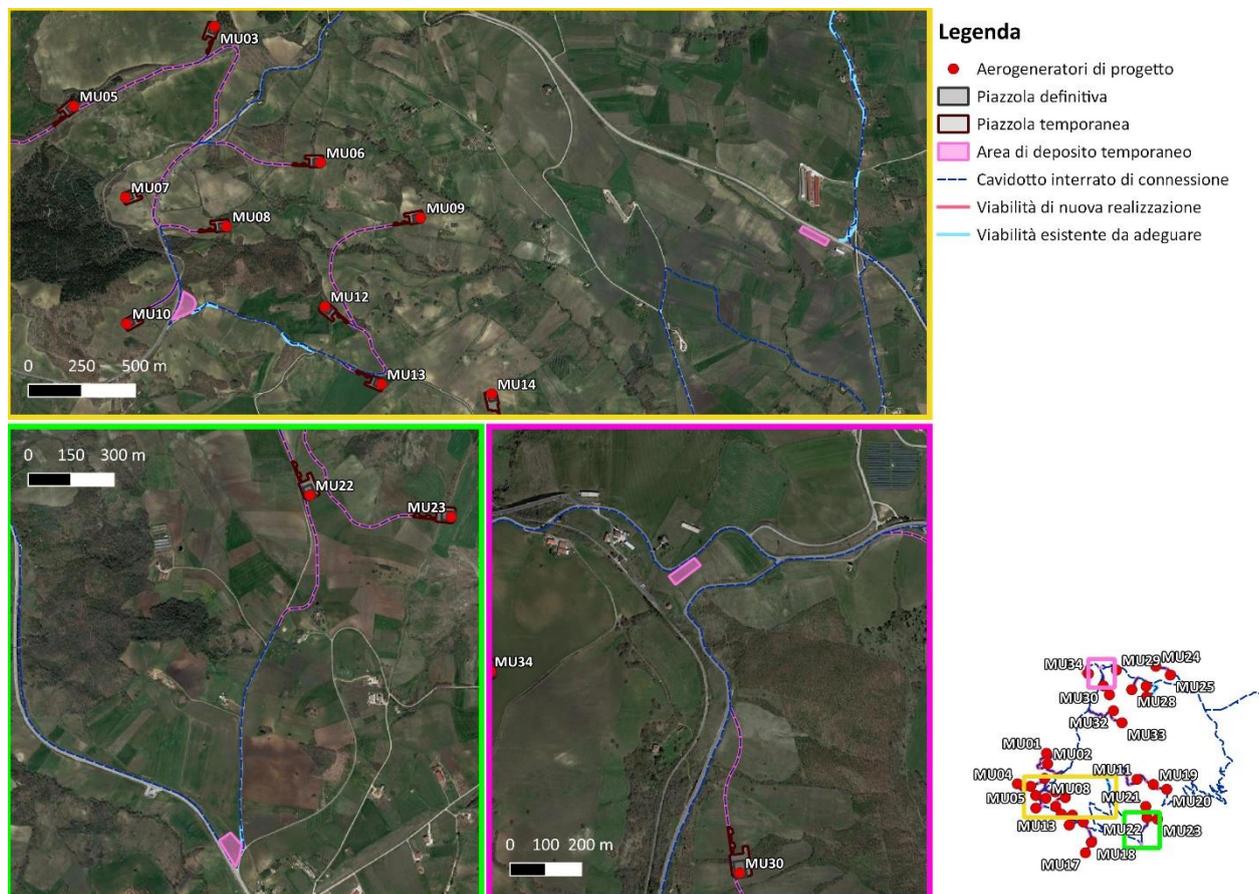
Localizzazione delle aree di deposito temporaneo per la fase di cantiere all'interno dell'impianto.
